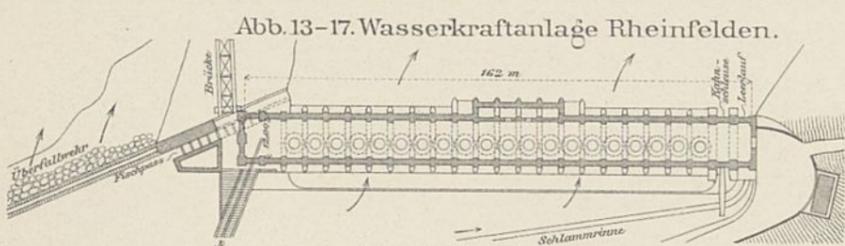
Turbinenhaus. Grundriss. 1: 2300.
